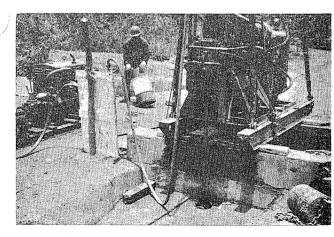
Corte vertical anclado para dar espacio a la construcción de un edificio. Las secciones individuales llegan hasta 16 metros de altura. El sostenimiento es discontinuo y la roca es contenida entre columnas ancladas por efecto de arco
